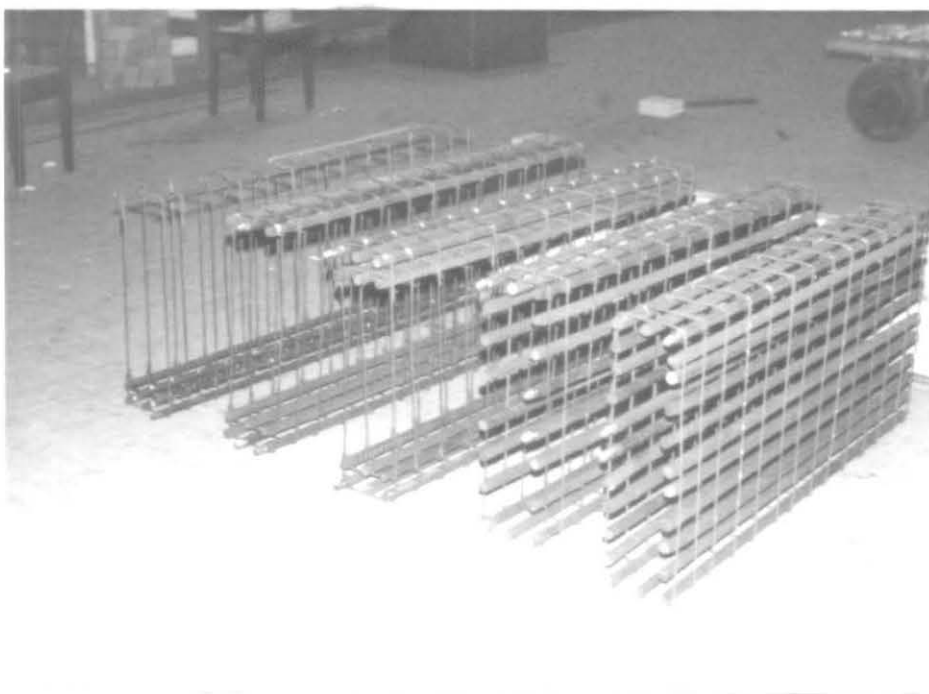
Vista geral das armaduras dos Modelos
